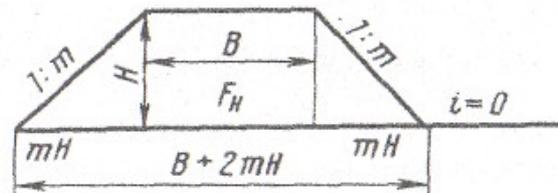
Схема для определения площади поперечного сечения насыпи
